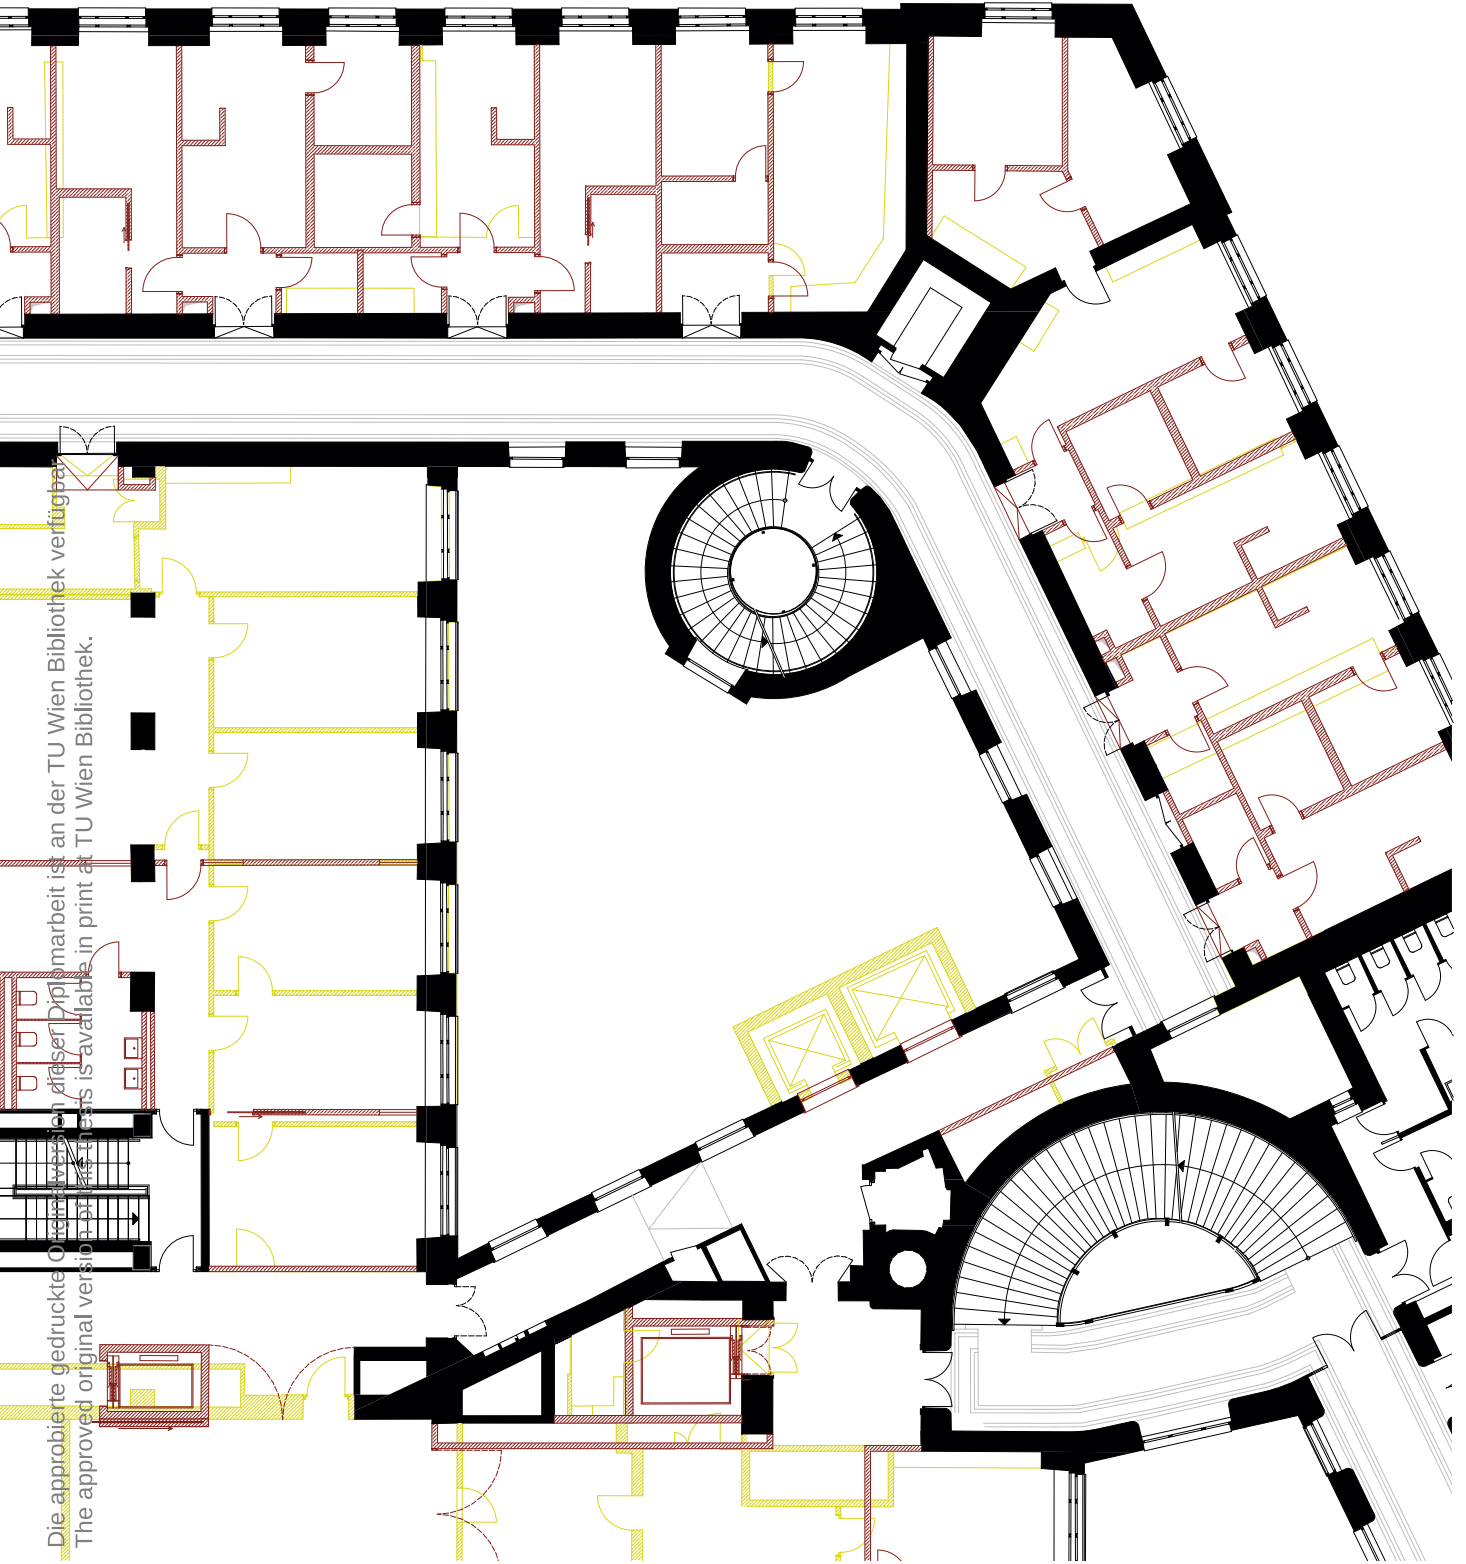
Entwurfsplan Grundriss 3. Obergeschoß
